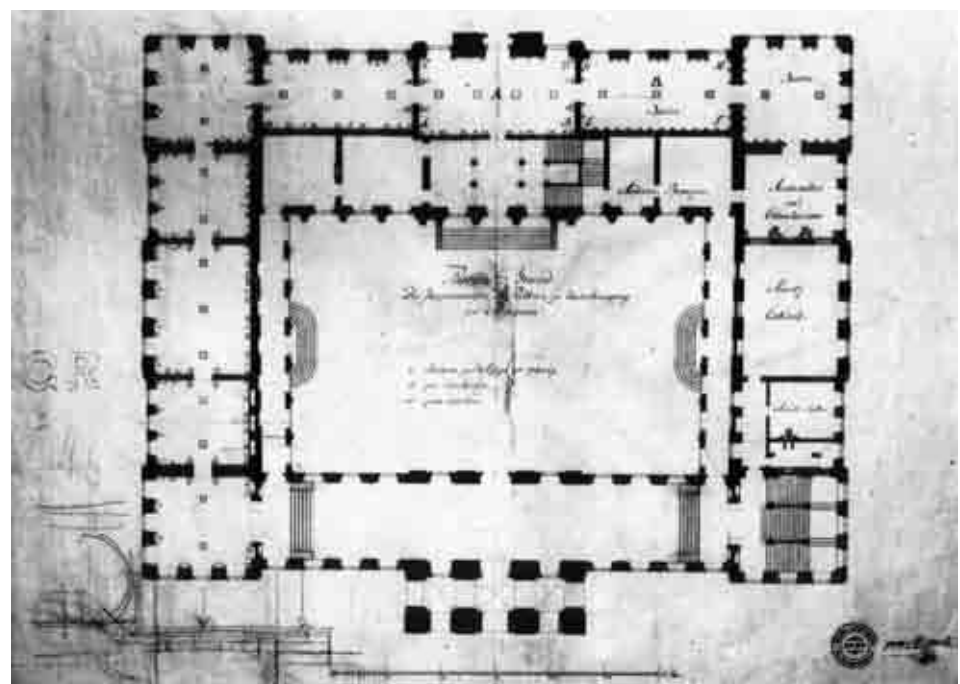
(#170) Grundriss Antikensammlung, Japanisches Palais, Dresden, um 1786.
